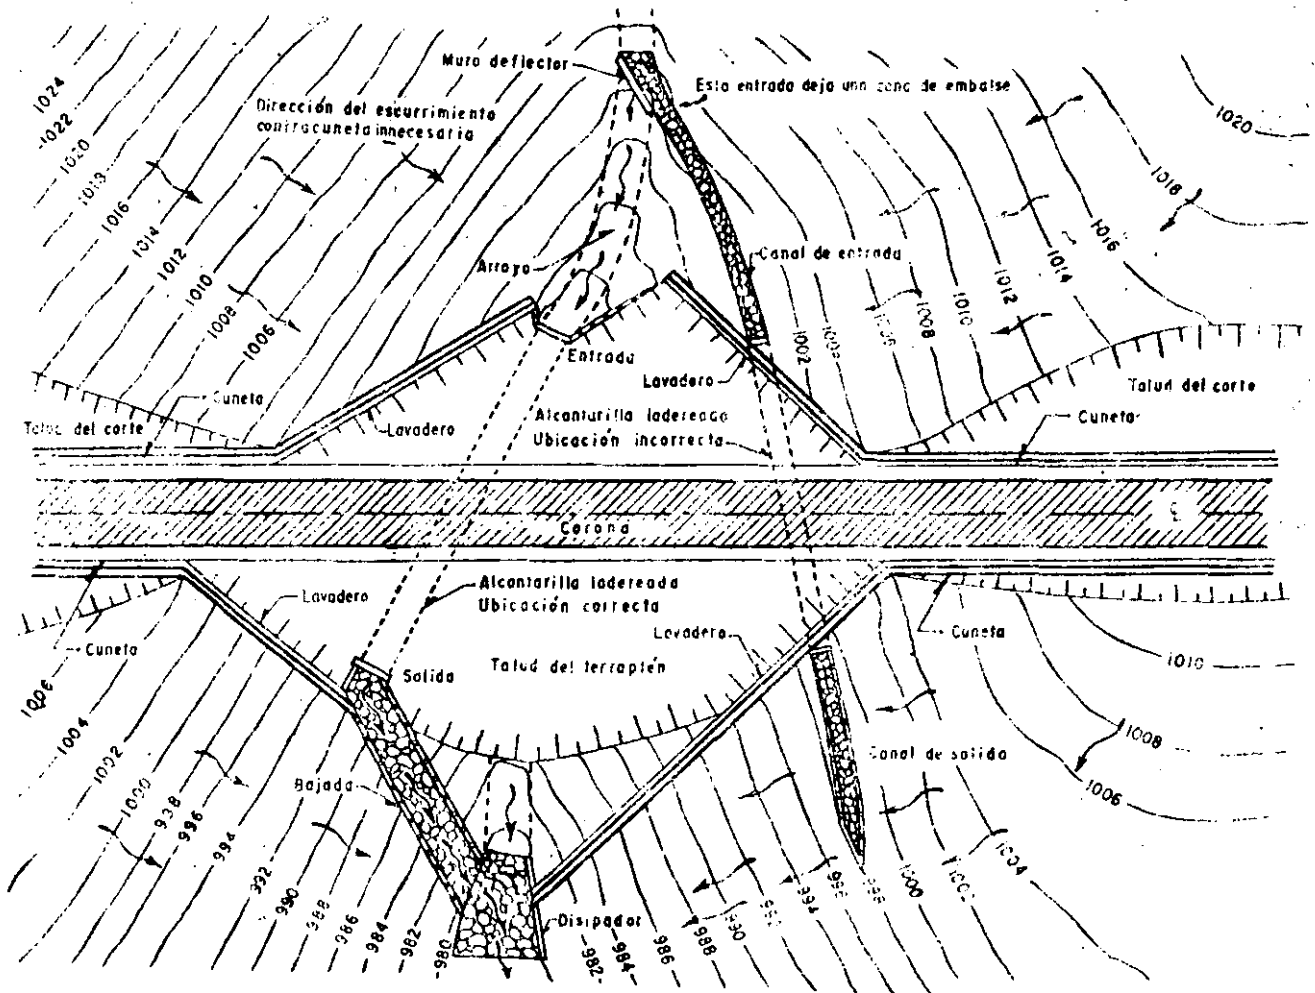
Ubicación de alcantarillas en laderas de cañadas.
